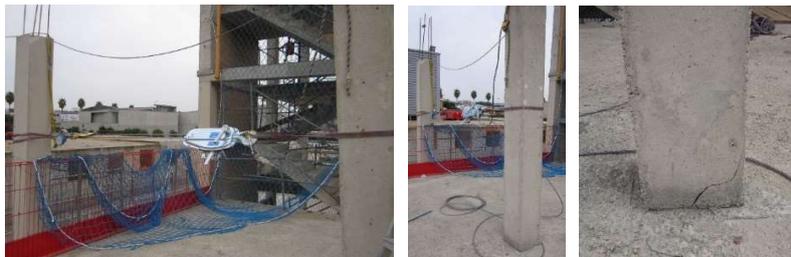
Vistas de la prueba y estado final de uno de los pilares situado en el centro del forjado.
